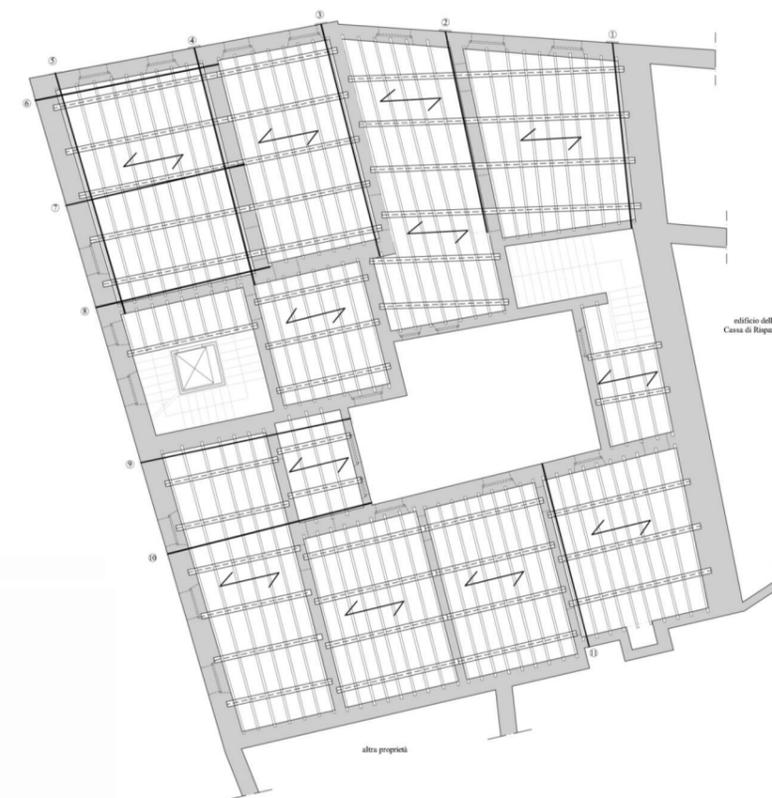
Carpenteria del solaio tipo e disposizione degli incatenamenti.
